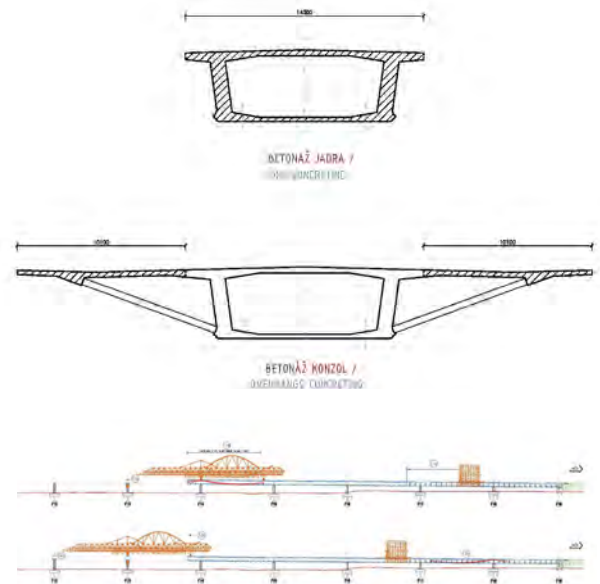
Fases de construcción de la sección tipo del tablero. Detalle del proceso co
